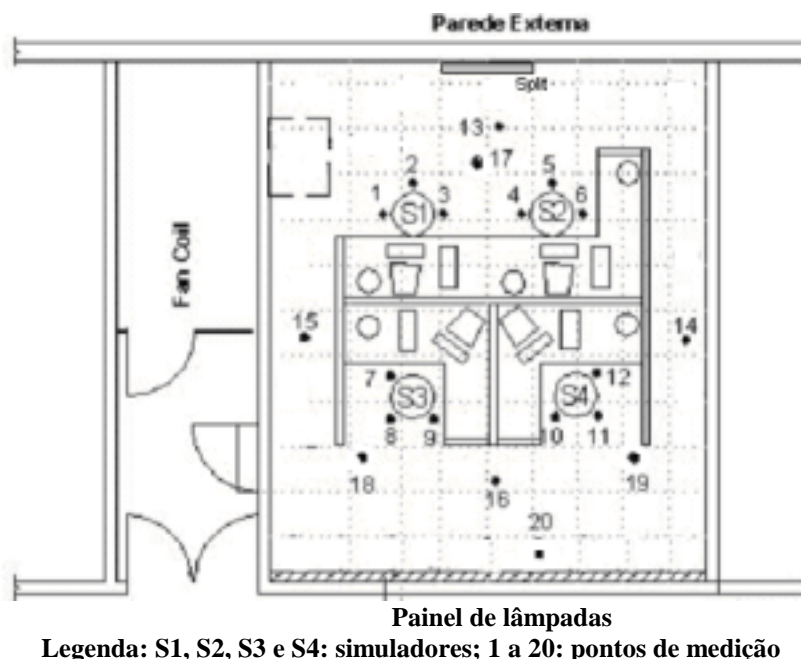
Planta baixa do laboratório e pontos de medição (adaptado de Leite e Tribess, 2002).
